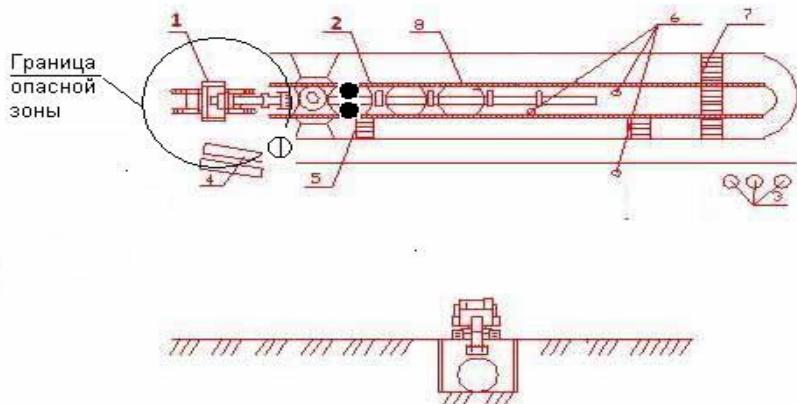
Схема производства работ по укладки стеклопластиковых труб
